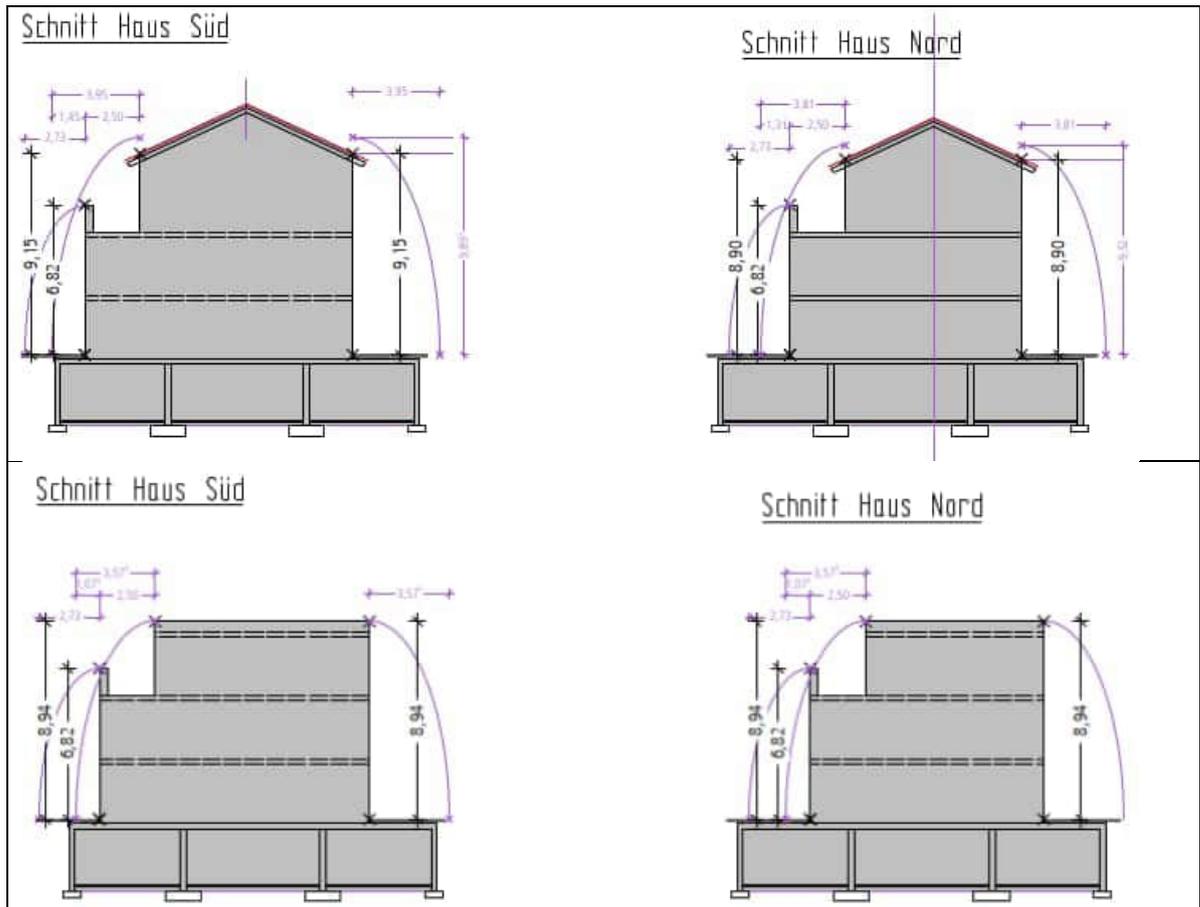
Planung Mehrfamilienwohnhaus mit Dachgestaltung als Satteldach [oben] oder als Flachdach [unten] gemäß [b] (Verfasser: Ingenieurbüro Leis, Reichling)
